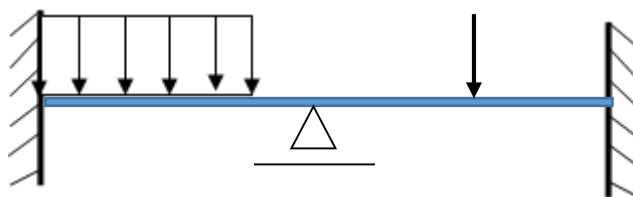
cas d'une poutre appuyée à double encastrement.
